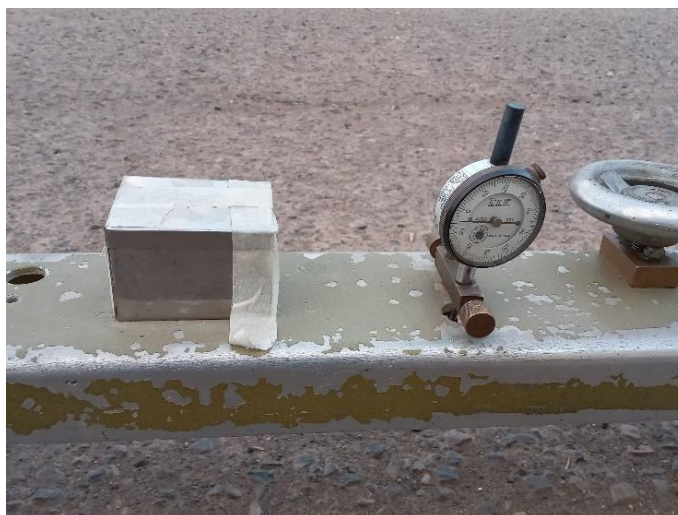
Vibrador y extensómetro de la Viga Benkelman
